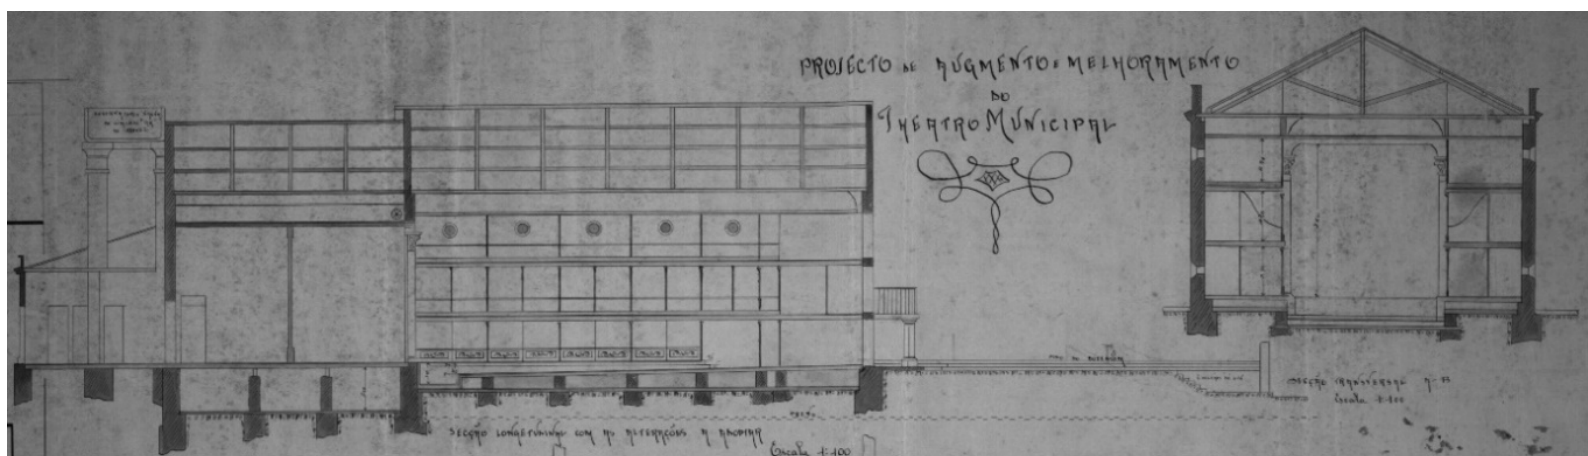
Planta - Levantamento do Teatro Municipal – 10 Out 1921
